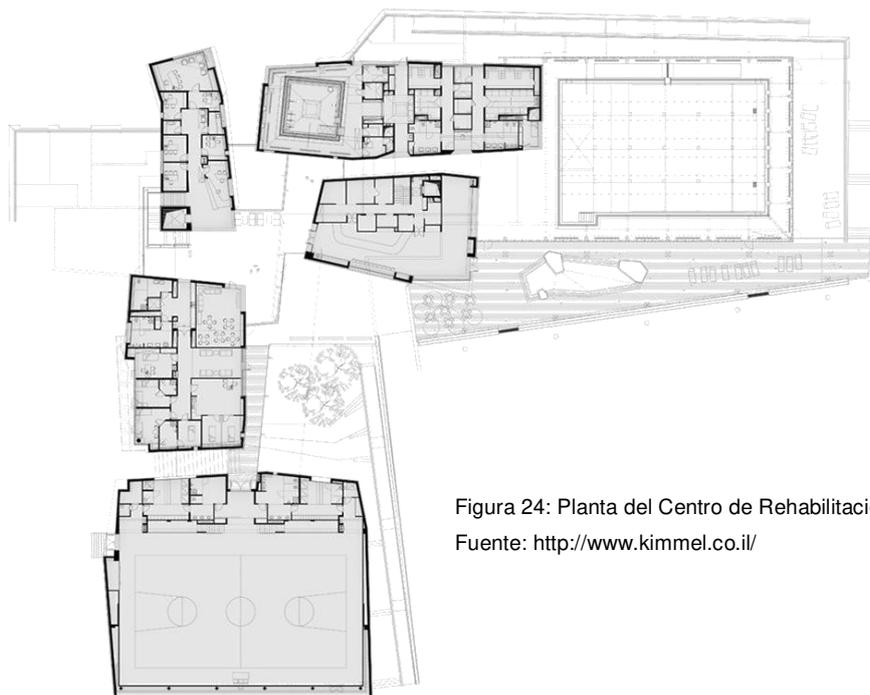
Planta del Centro de Rehabilitación Beit Halojem
